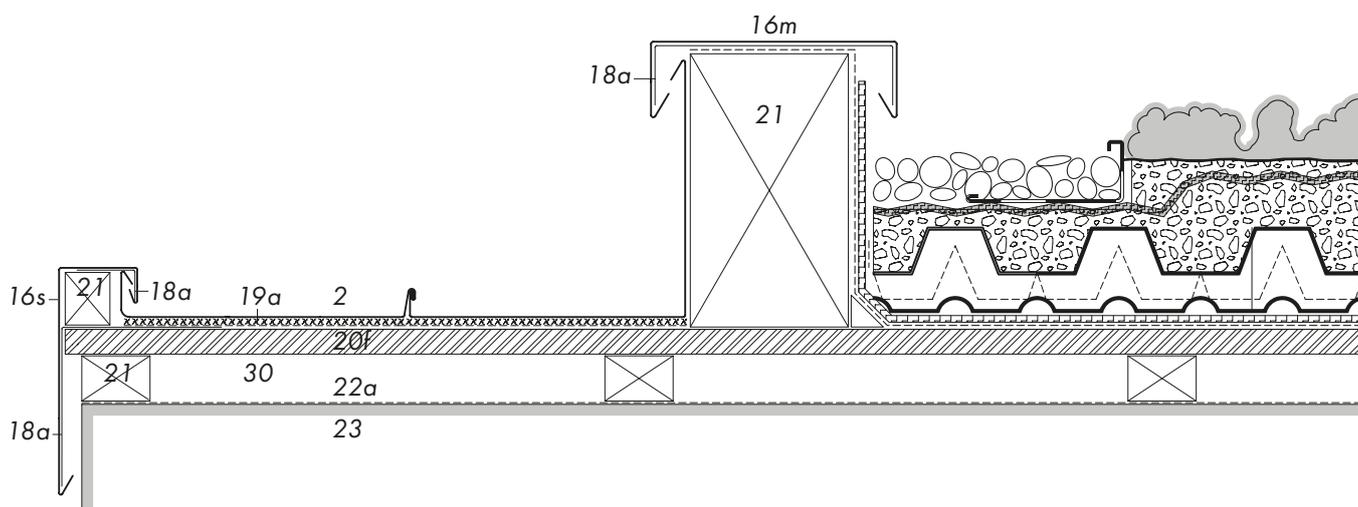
Detalle de borde - Conexión lateral a cubierta con vegetación
